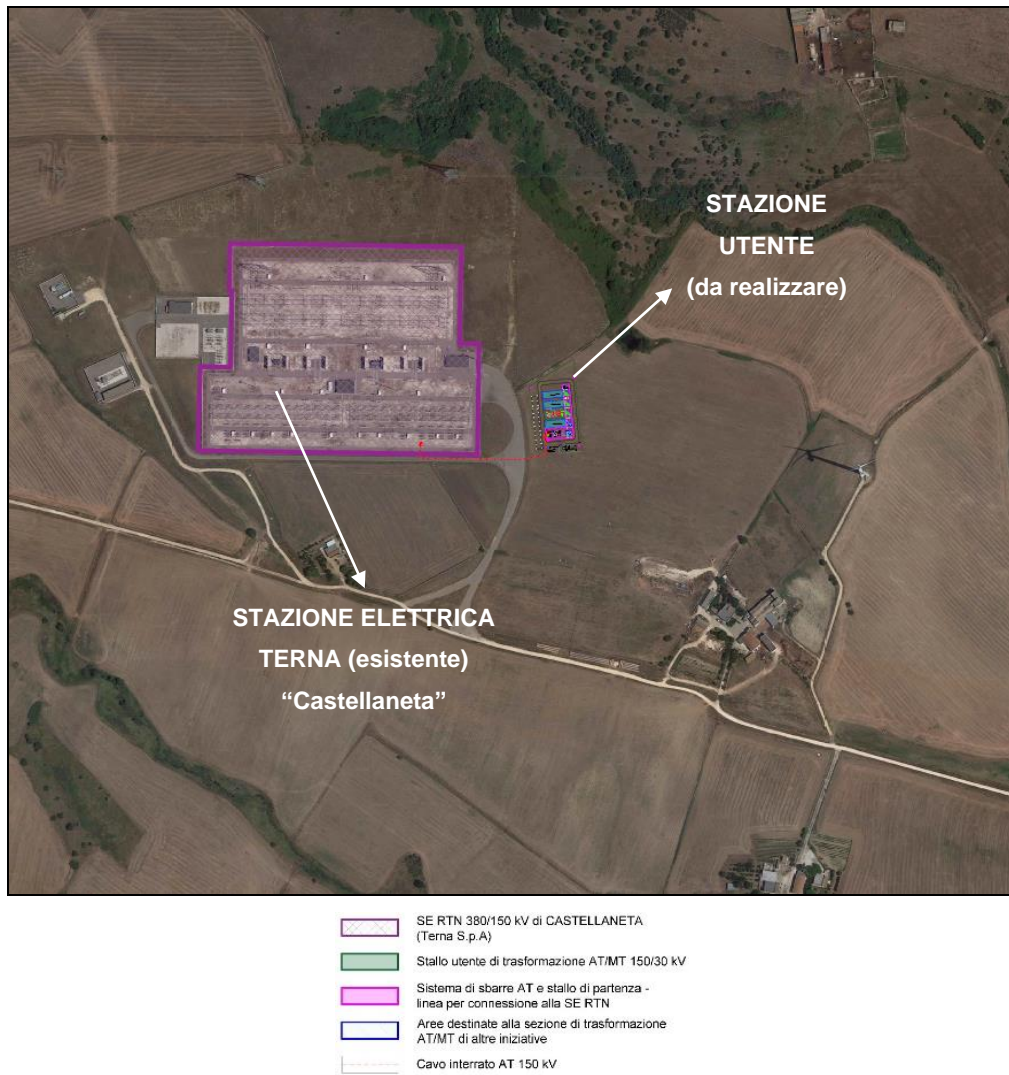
Stazione utente e stazione elettrica su ortofoto
